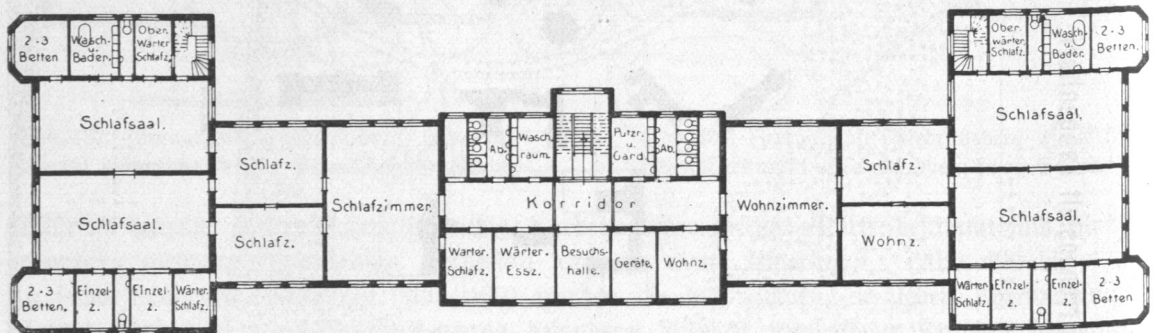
Irrenanstalt Langenhorn, Pflegehaus für 150 Männer und 19 Wärter, Obergeschoß, Grundriß.
